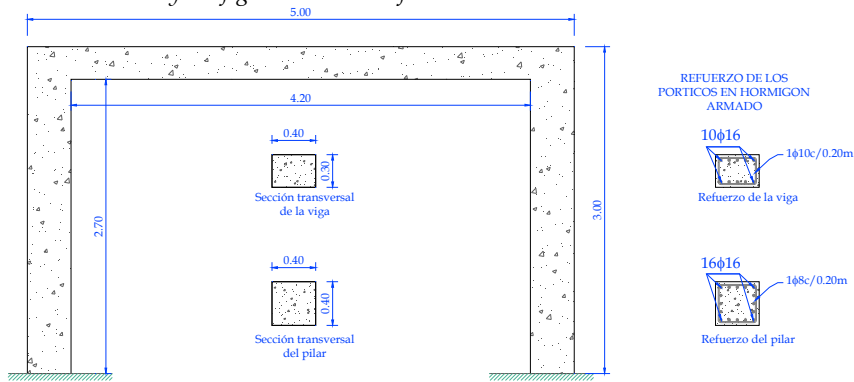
GEOMETRÍA TIPO DE LAS ESTRUCTURAS PORTICADAS [100]
